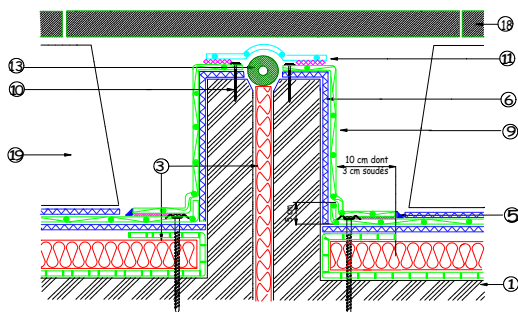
joint de dilatation plat surélevé sur maçonnerie avec dalles sur plots
